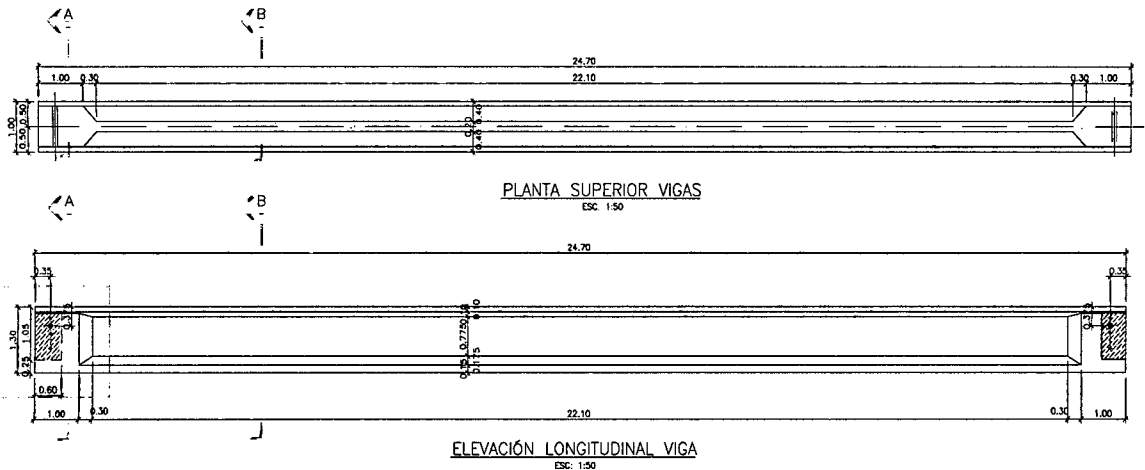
Dimensión de las Viga Típica  $h=1.30$  y  $L=24.70$ m, vista en Planta y elevación.
